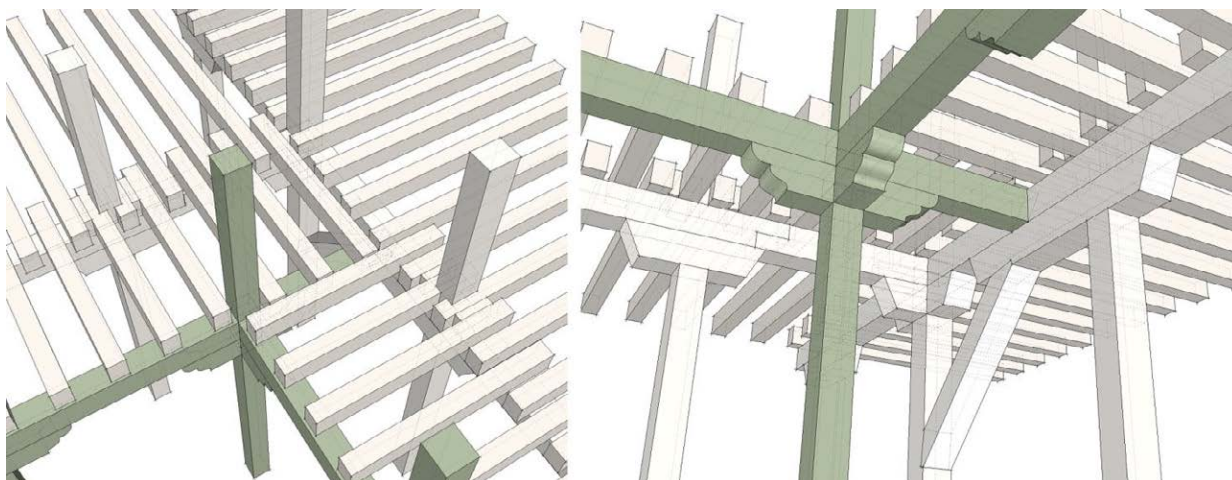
Refuerzo de la carrera del muro con jabalcón, para apoyo de la carrera del corredor
